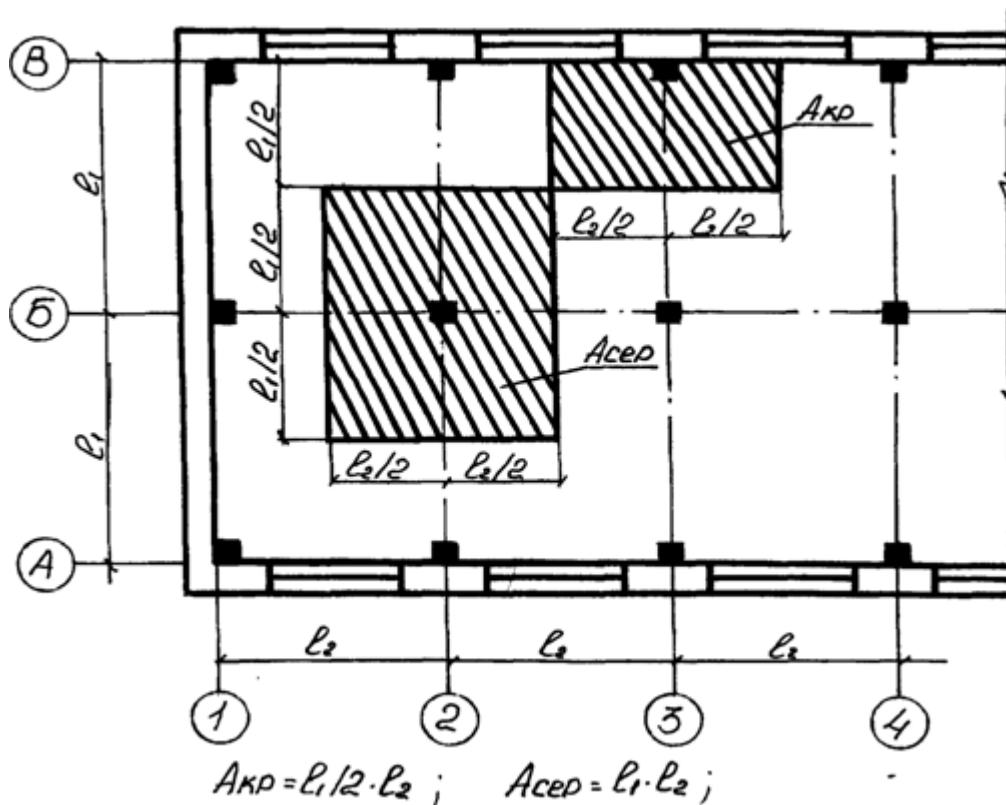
Схематичний план будівлі та вантажні площі для розрахункових фундаментів
